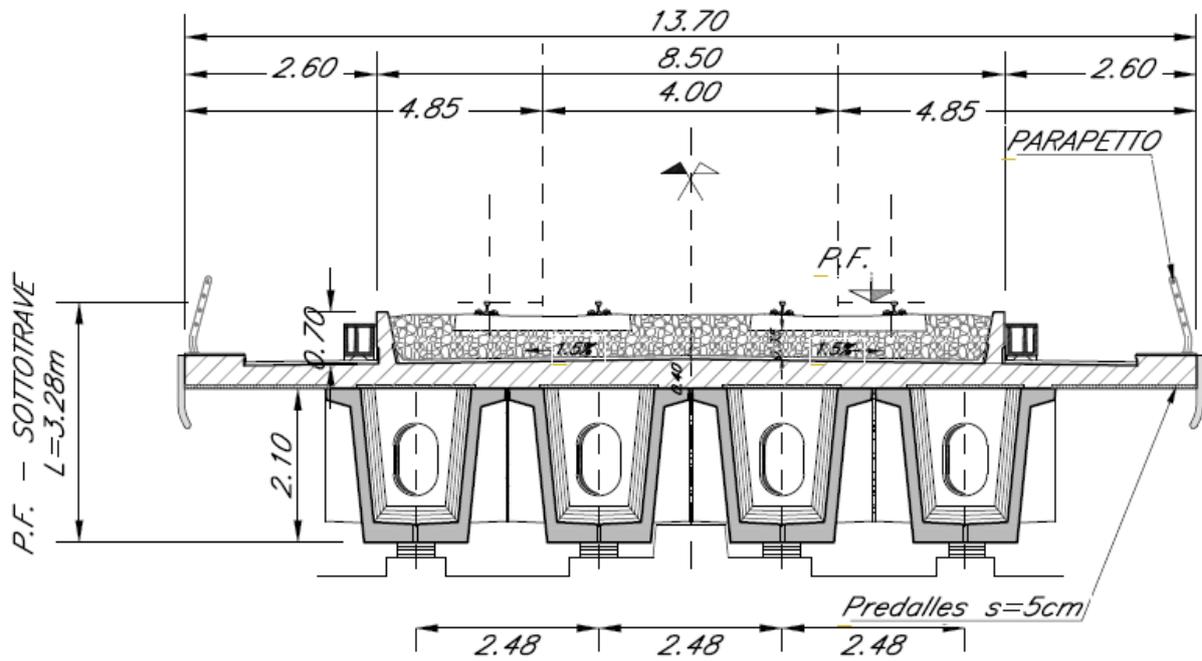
sezione trasversale dell'impalcato C.A.P. 25m
